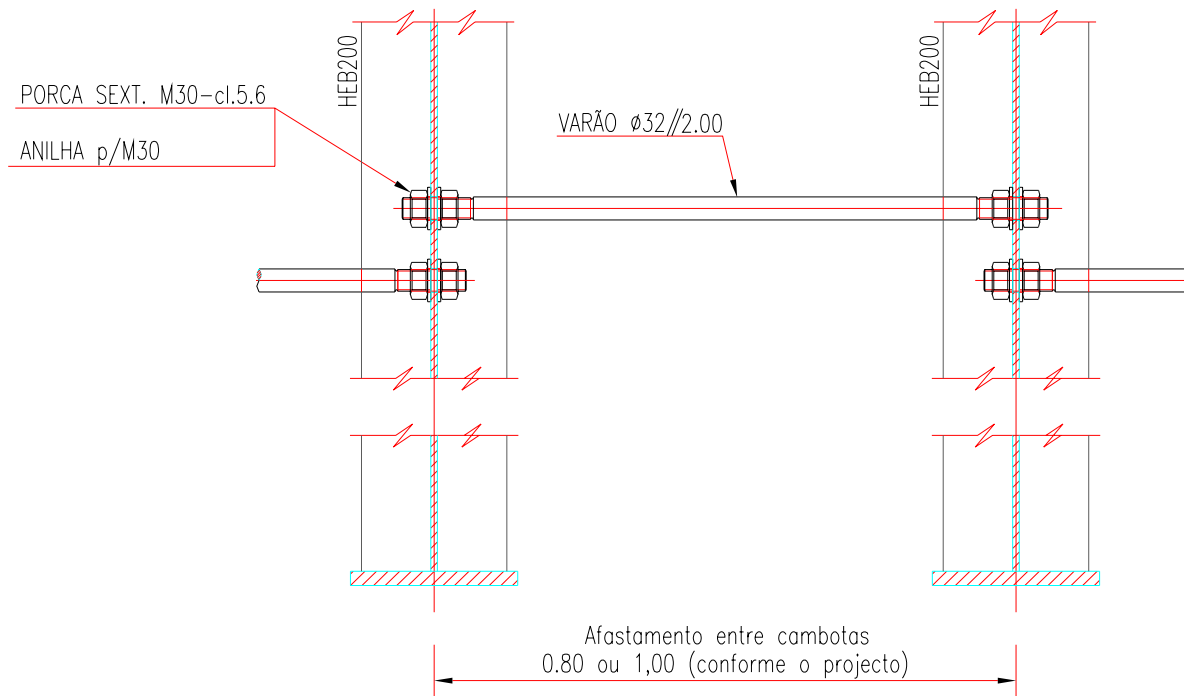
Pormenor do contraventamento das Cambotas [19]
